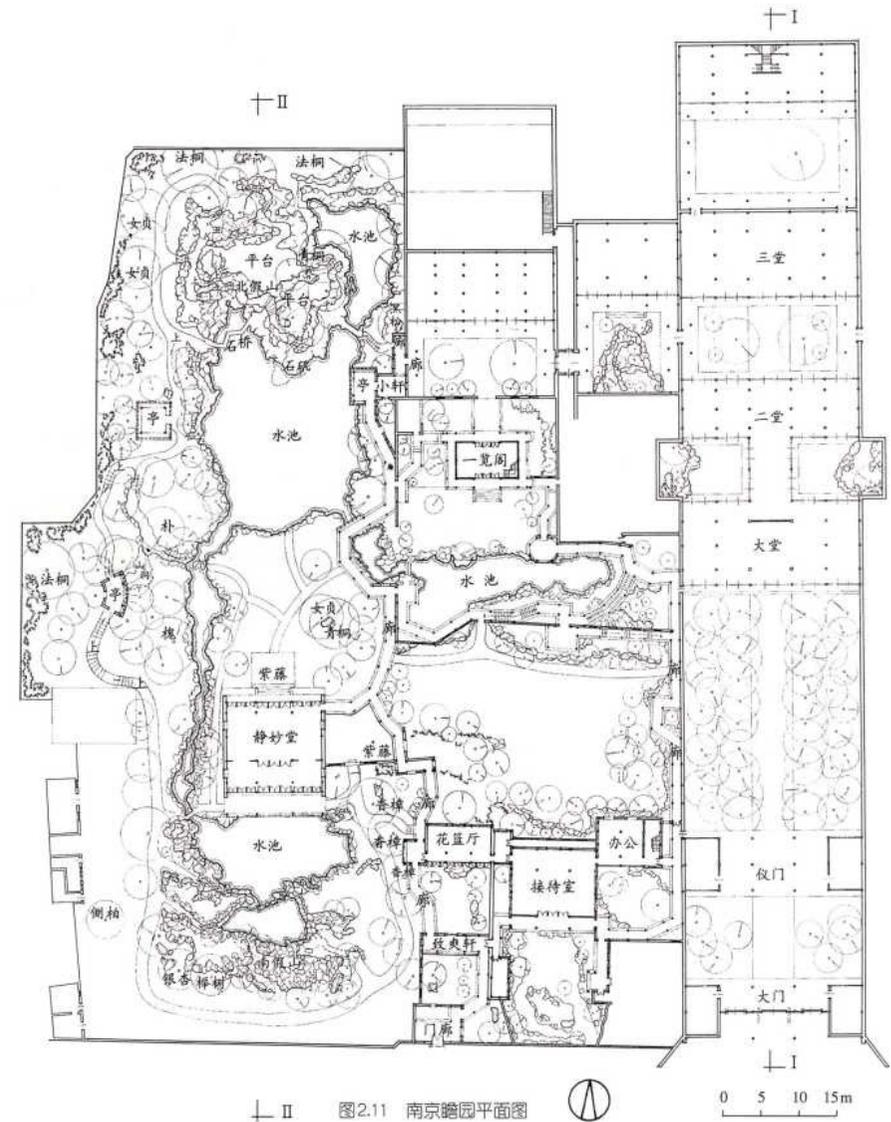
瞻园平面图，明代，南京，中国。Traducción: Plano de planta de Zhanyuan, Dinastía Ming, Provincia de Nanjing, China. (Imagen extraída en red: baidu.cn)
